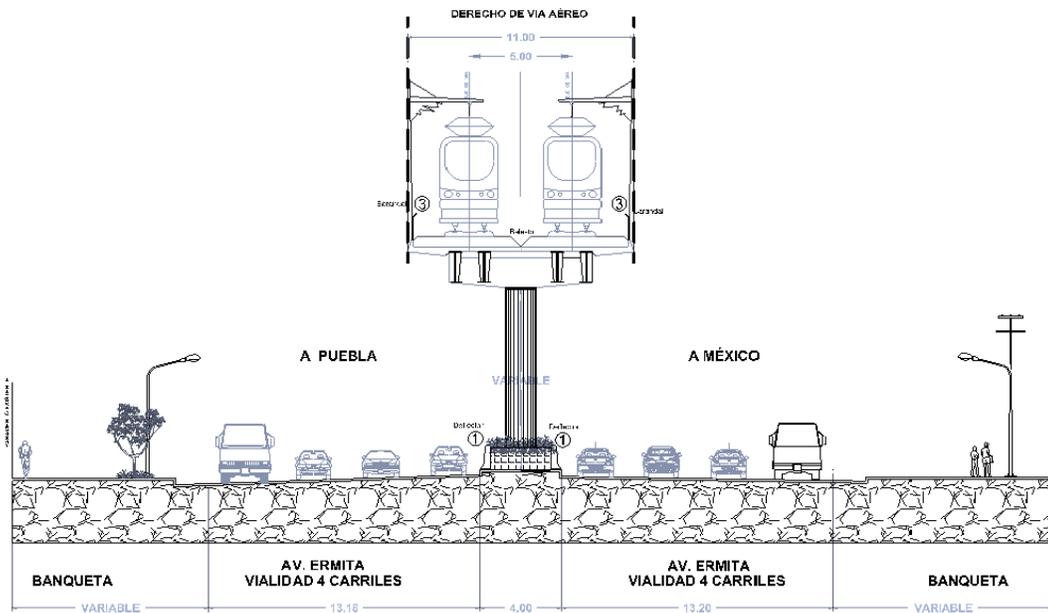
Sección tipo de estructura elevada sobre Ermita – Iztapalapa.
